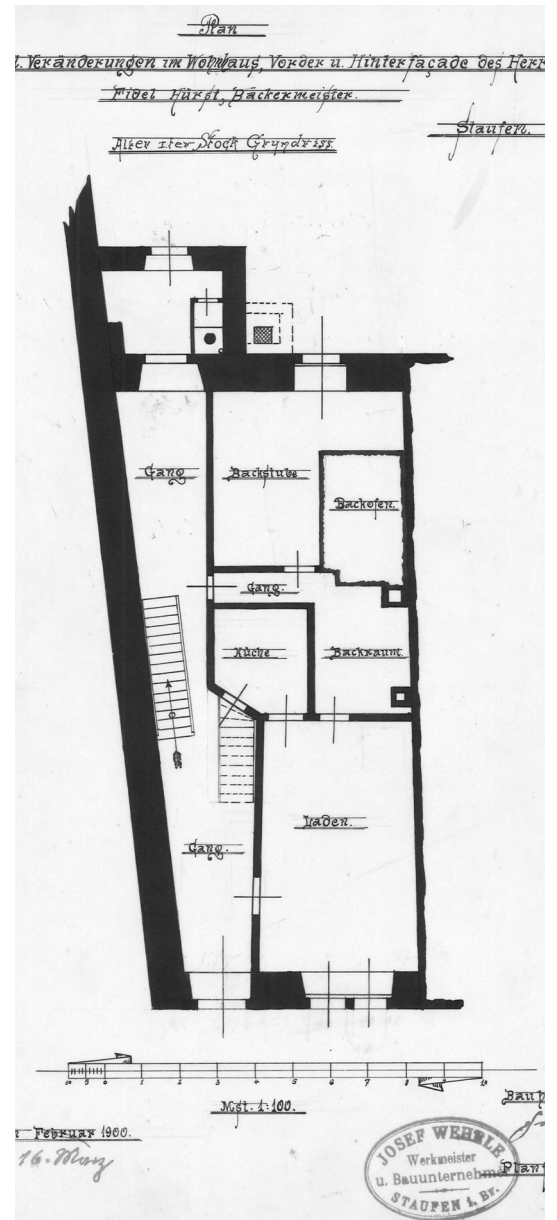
Hauptstraße 51, Grundriss Erdgeschoss, Plan von 1900.
